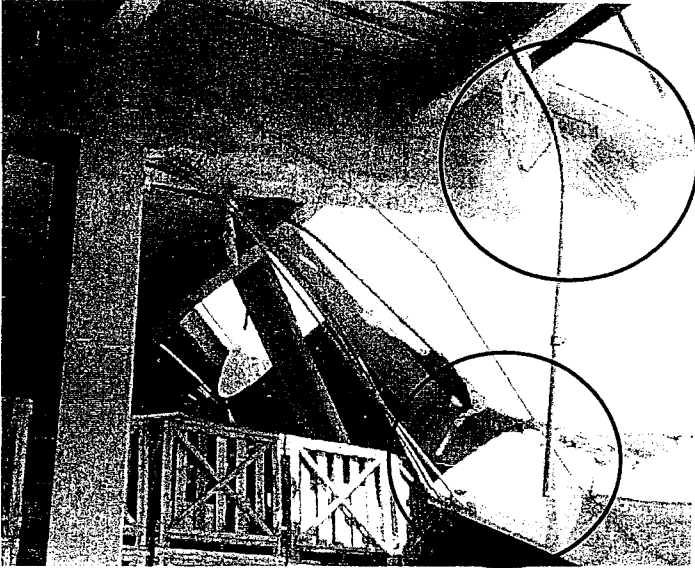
Falla por corte en una viga de un sistema liviano de techado.
